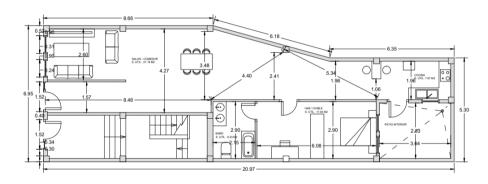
Plano acotado estado reformado. Fuente: Propia.
